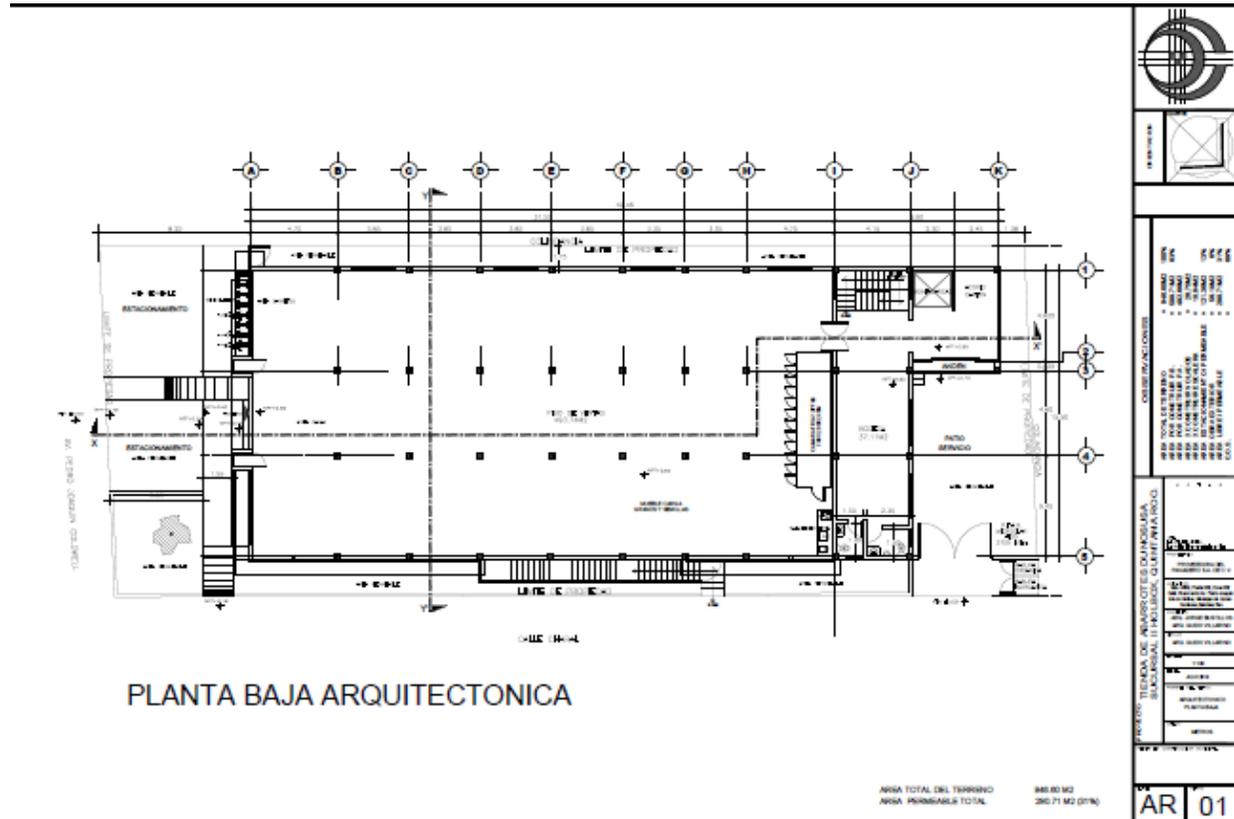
Planta arquitectónica del proyecto (planta baja)
